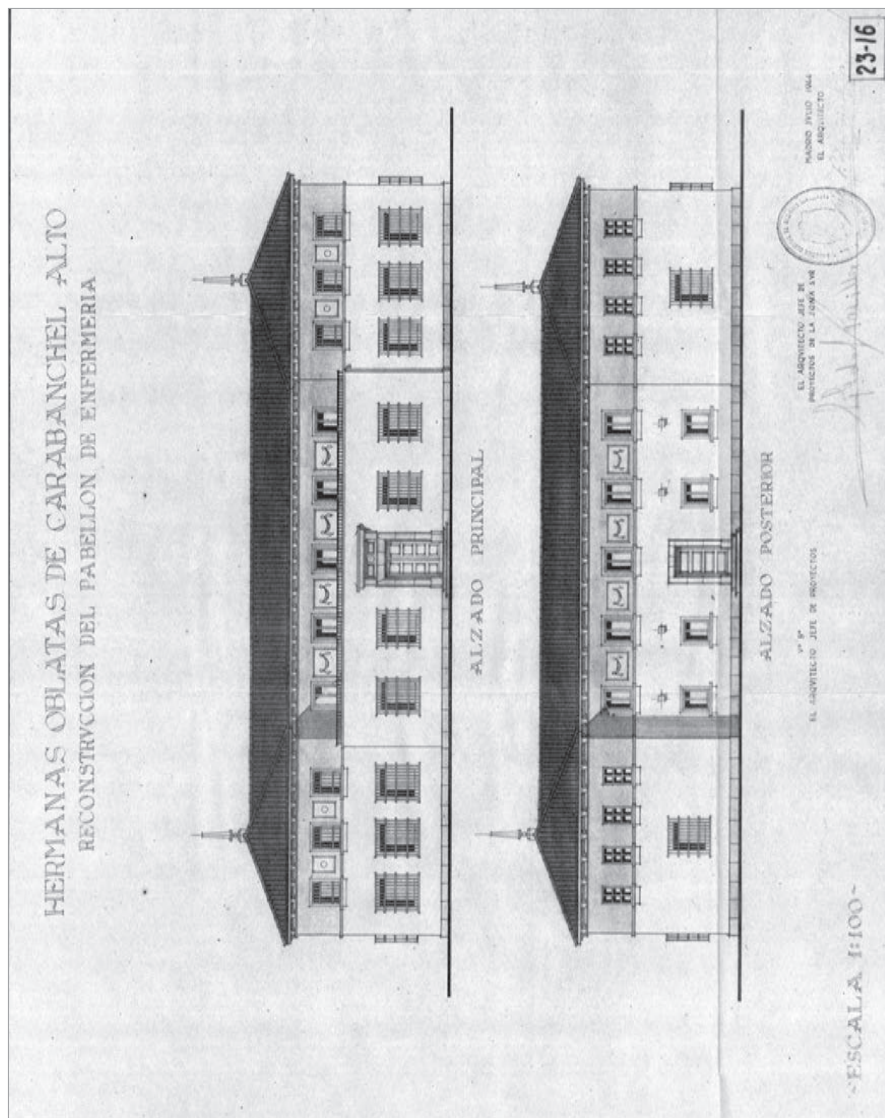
Pabellón de Enfermería del Convento de las Oblatas, Carabanchel Alto. Plano de alzados, 1944. AGA, FAD 26/16195, carpeta n.º 55; (2) 81.03 2582 Top 76/04.
